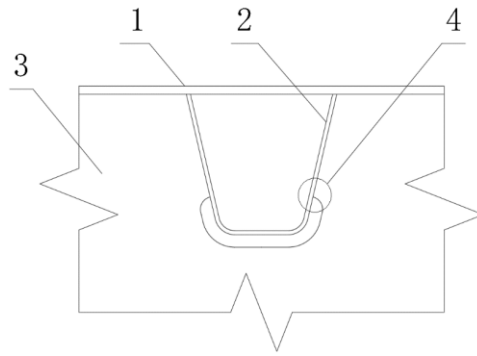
顶板与 U 肋焊缝测点布置 (mm)
